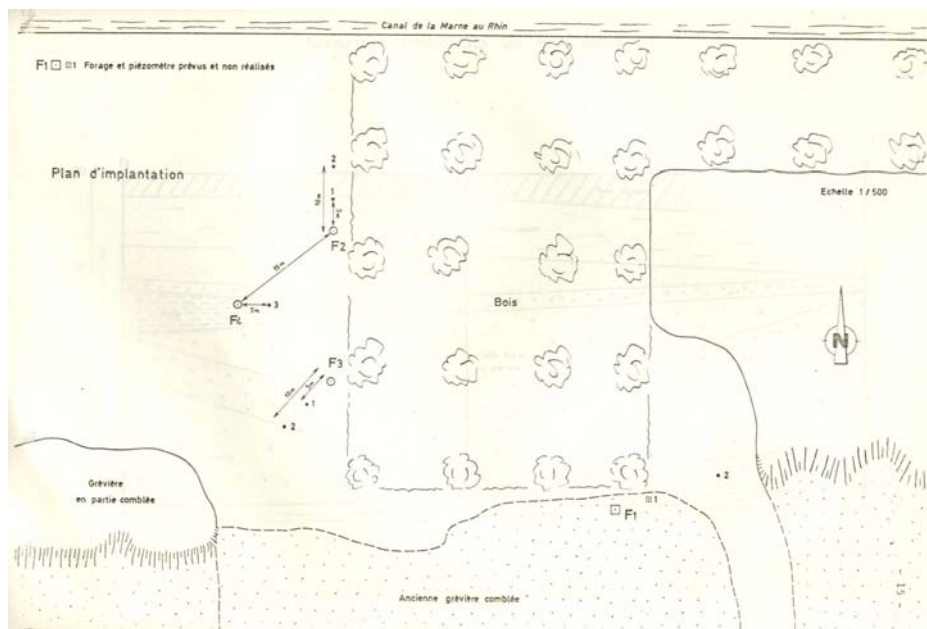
Plan de localisation des ouvrages réalisés sur le site d'UNION CHAMPAGNE MALT (Kerbaul et al., 1971)
